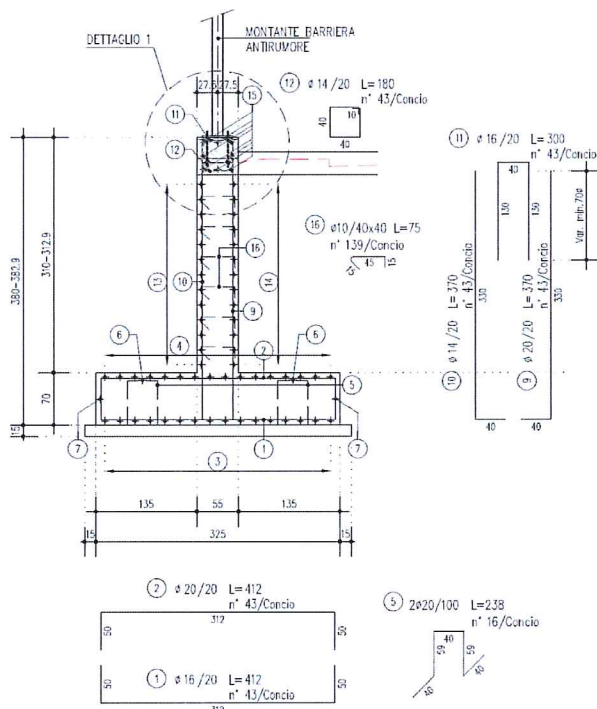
Schema armatura – Muro tipo 4 –Concio 42-43
